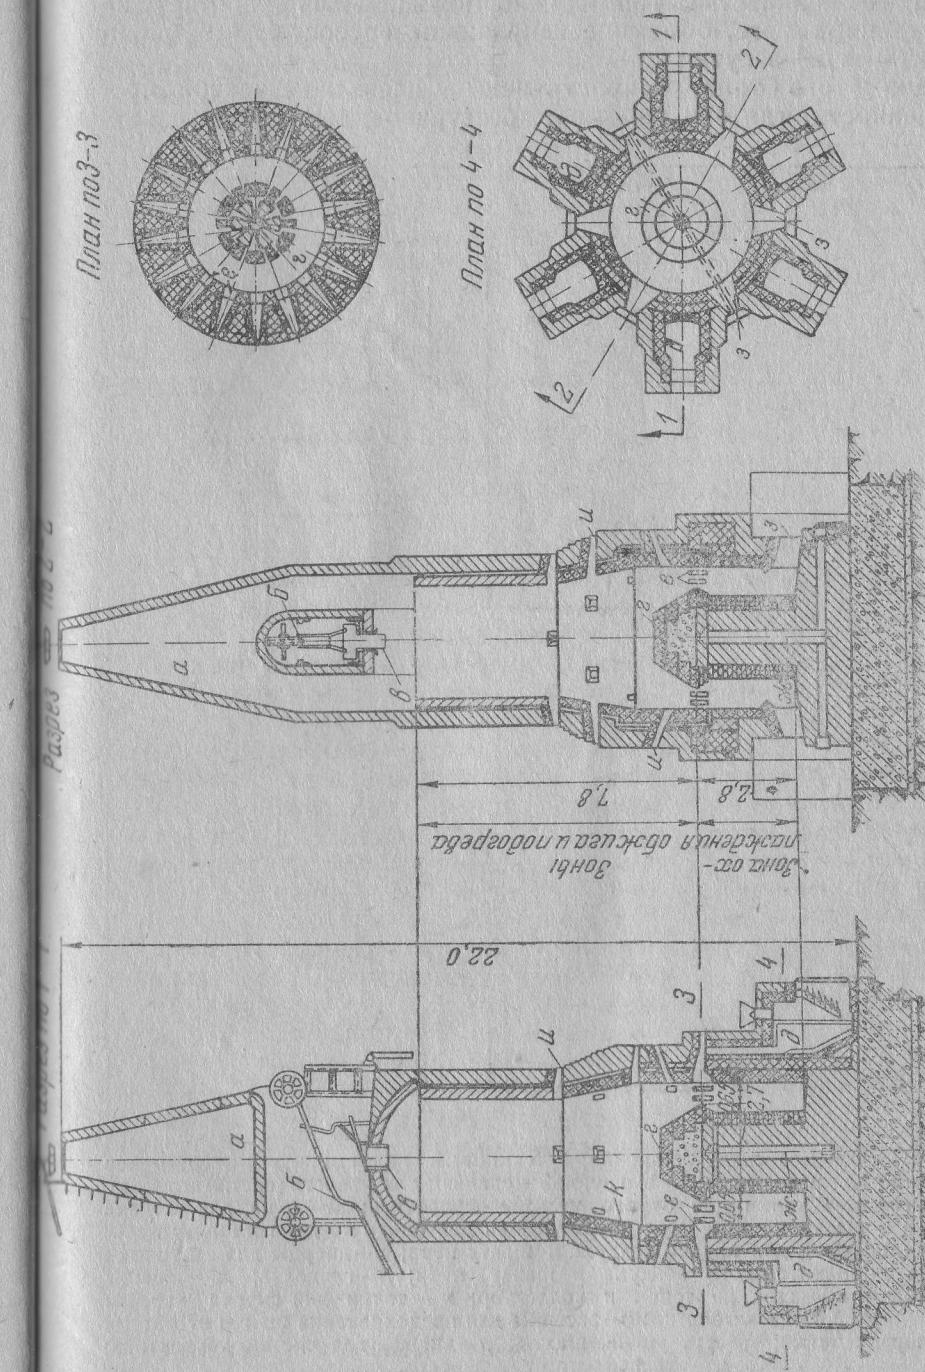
а—дымовая труба; б—скрепочный подъемник; в—затирочная коробка для известняка; г—керн; д—полугазовые топки для каменного угля; е—канал для впуска полугаза в шахту печи; ж—канал в керне для подачи воздуха; з—окна для выгрузки извести; и—глаяники; к—футеровка шахты
